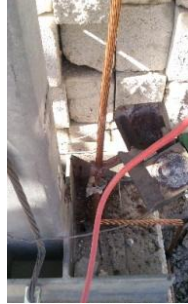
A la derecha el molde abierto, al centro la soldadura fallida que debió unirse a la estructura de la izquierda.
